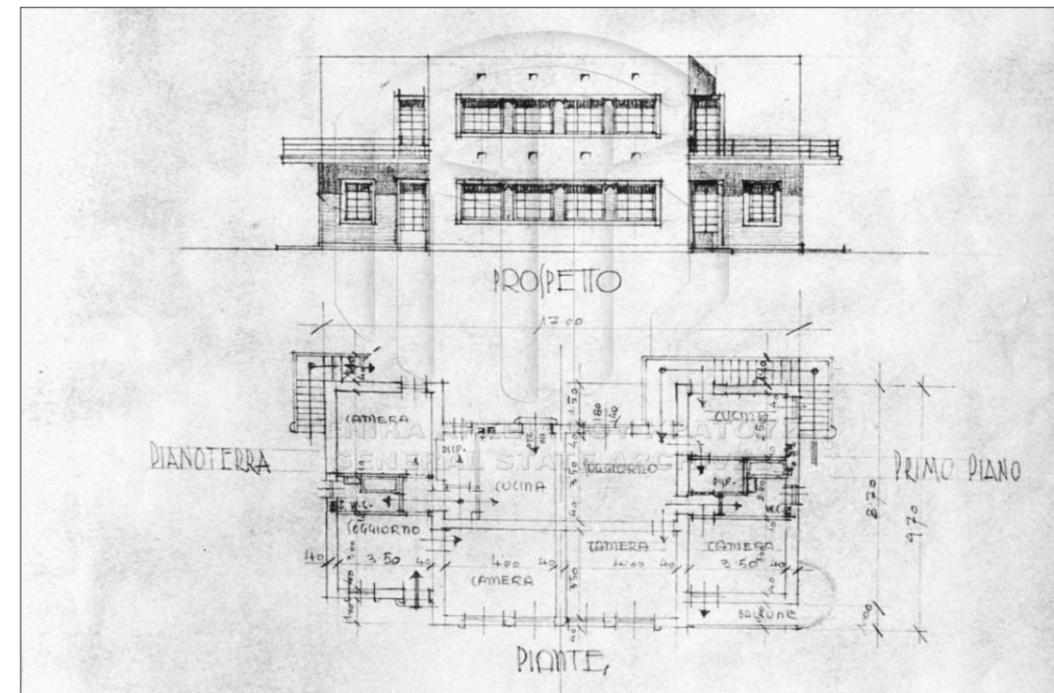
case sottufficiali 1.3, piante prospetto, sc. 1:100
